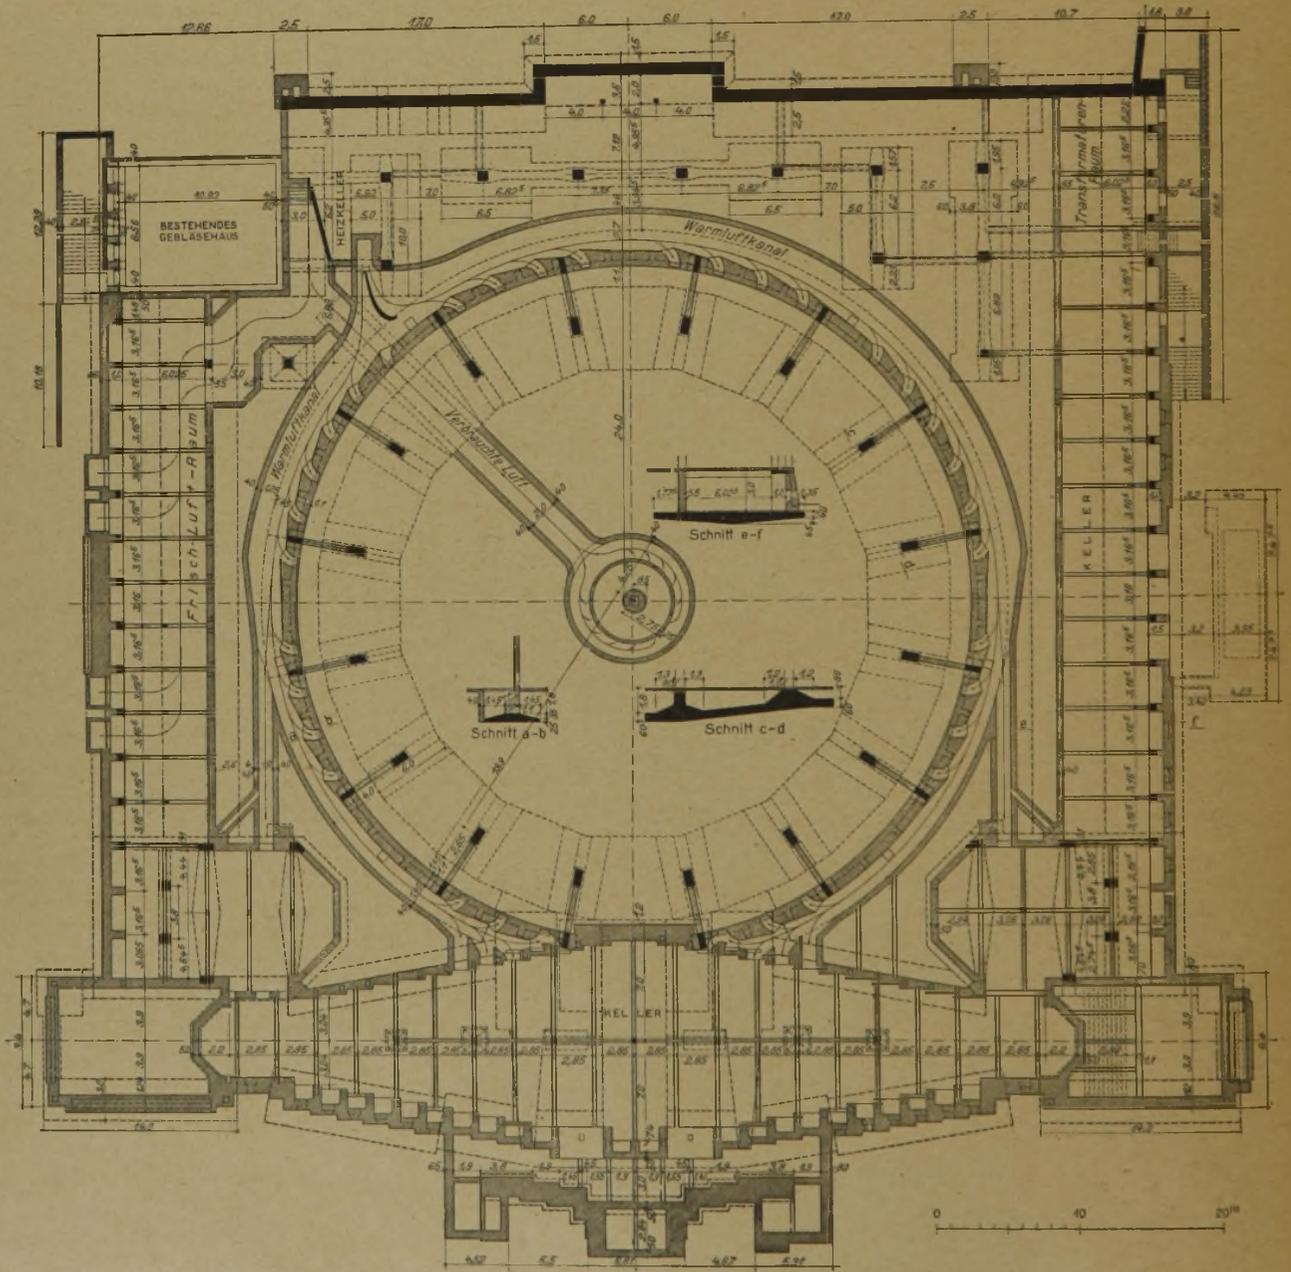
Grundriß des Fundamentes (rd. 1 : 500).
